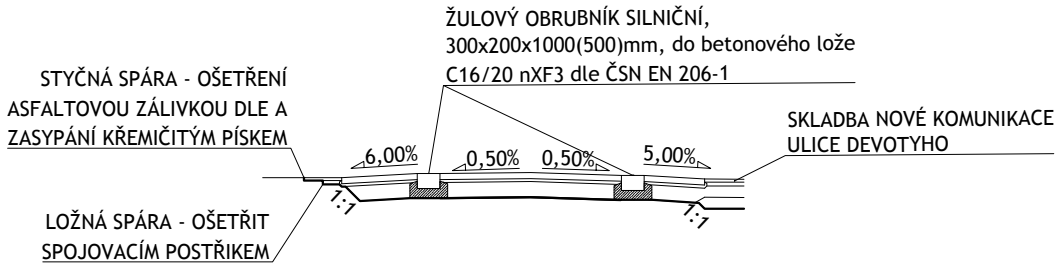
DETAIL PŘEJEZDNÉHO PRAHU M1:100
